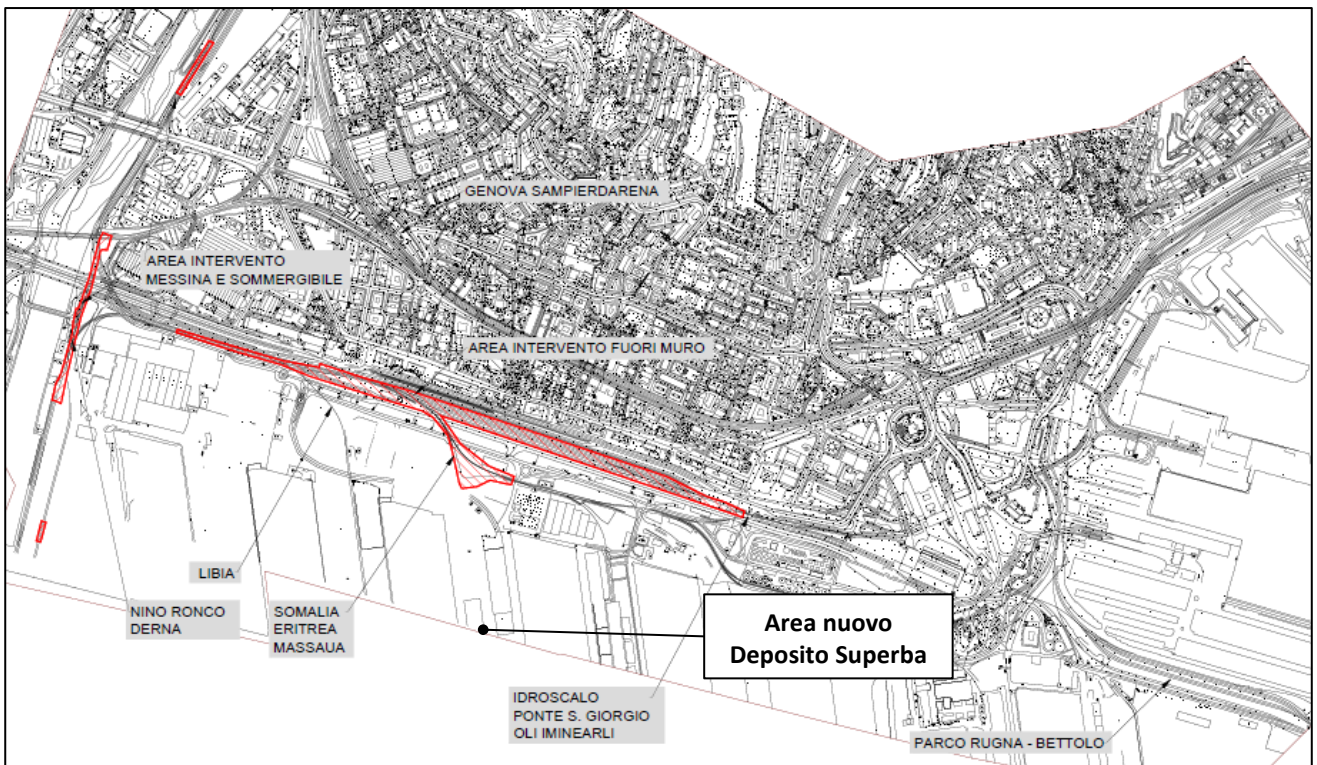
Estratto Planimetria area di Progetto “Bacino portuale di Sampierdarena Interventi Parco Fuori Muro”
